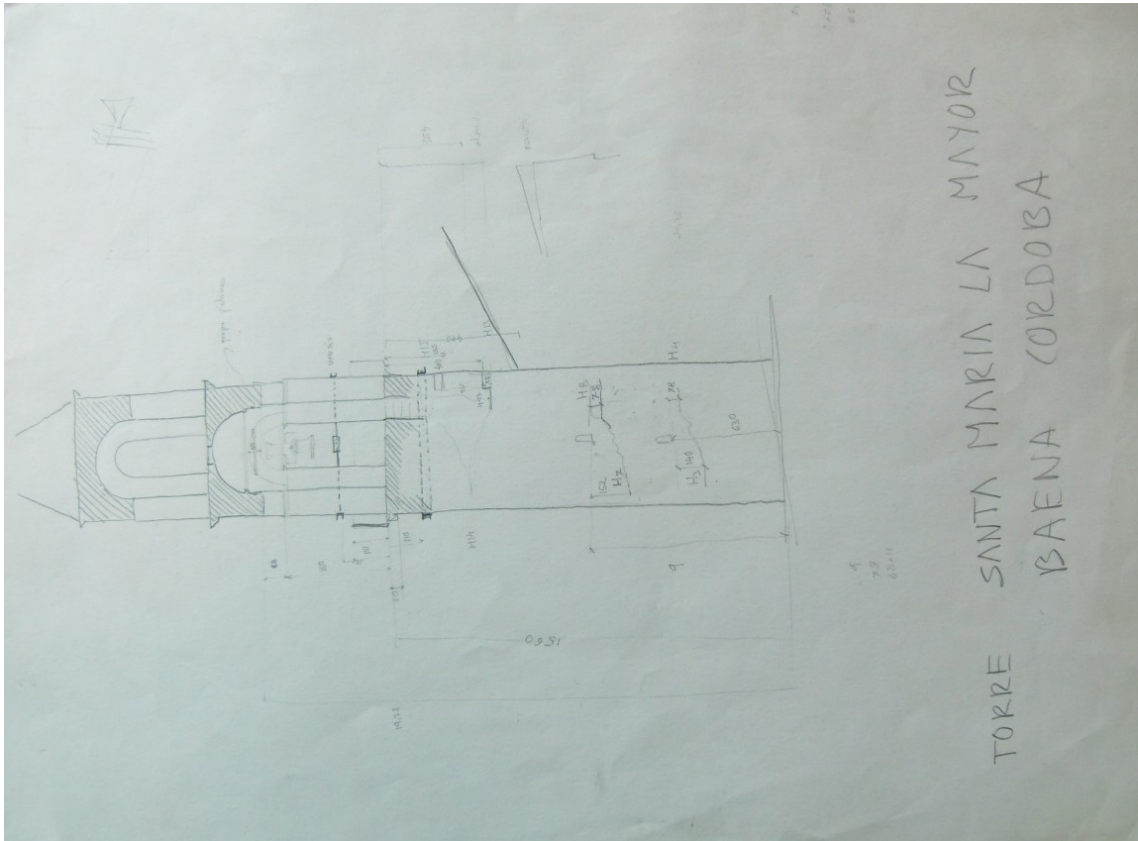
Sección torre - Croquis del levantamiento realizado por el autor
